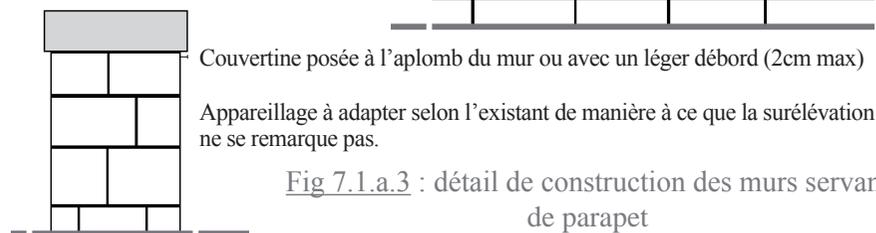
a.3 : détail de construction des murs servant de parapet
